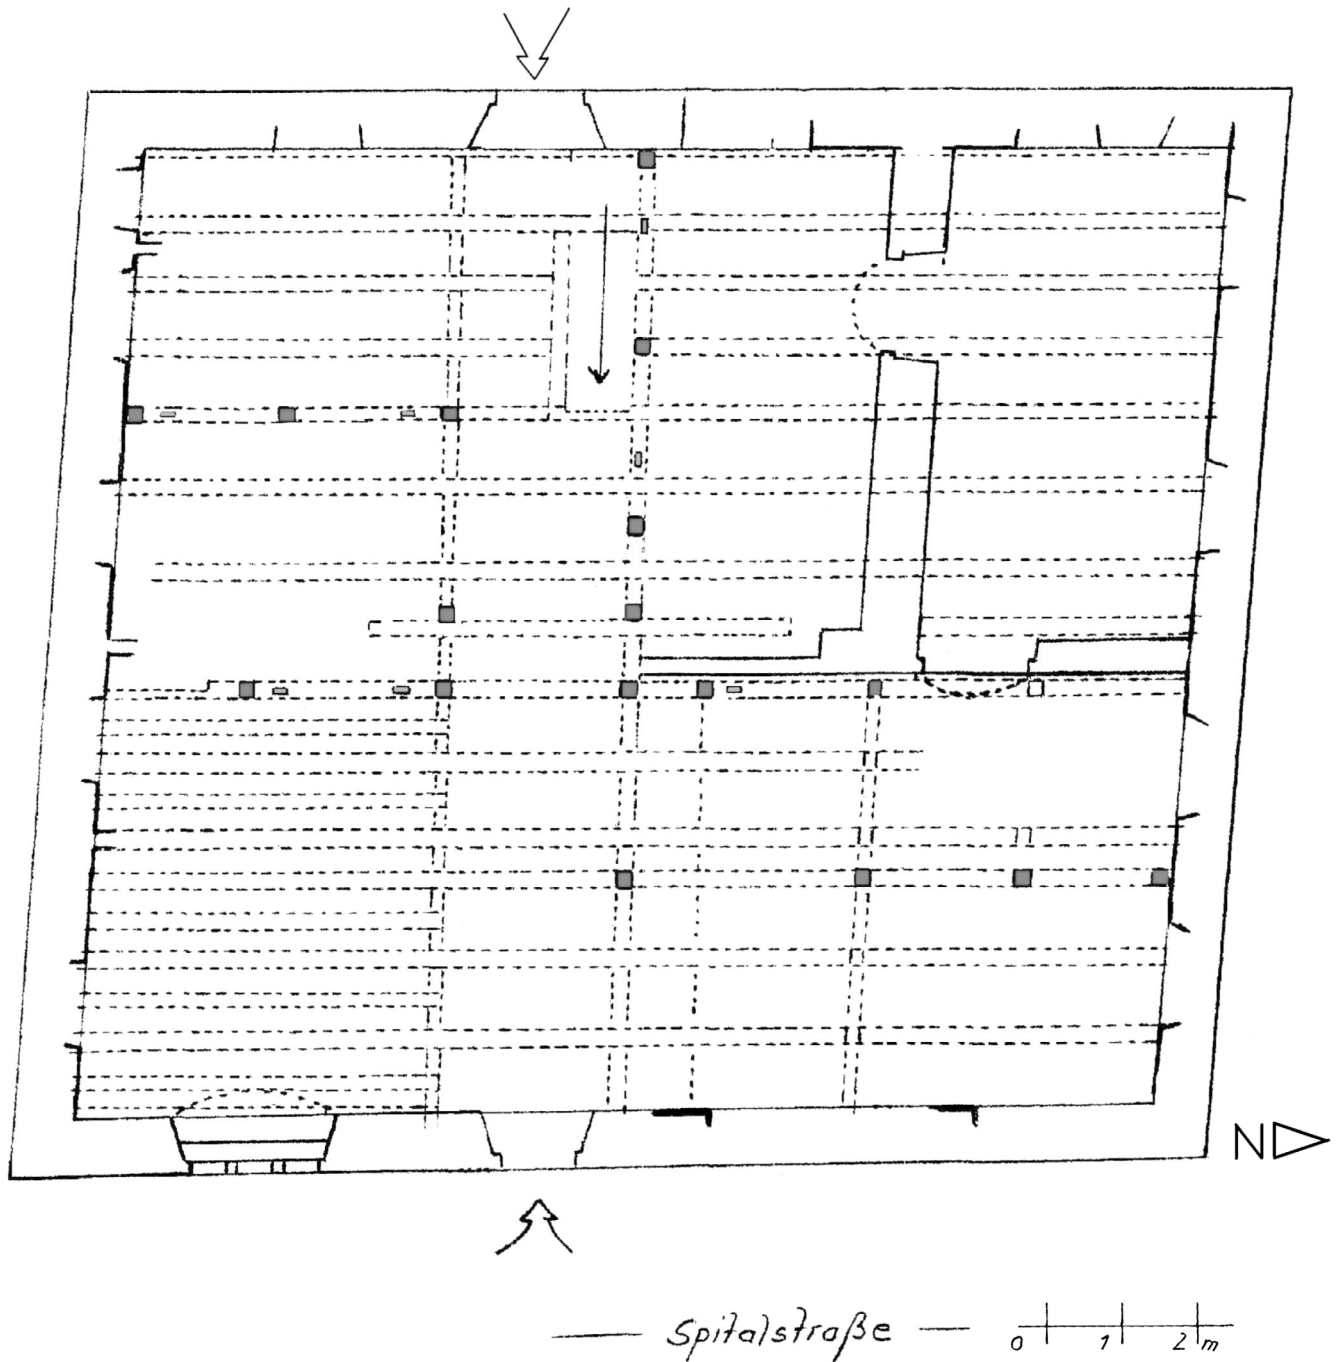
Spitalstraße 33, Grundriss Erdgeschoss mit bauzeitlicher Gebälklage und Ständerstellung von 1580 (d).
